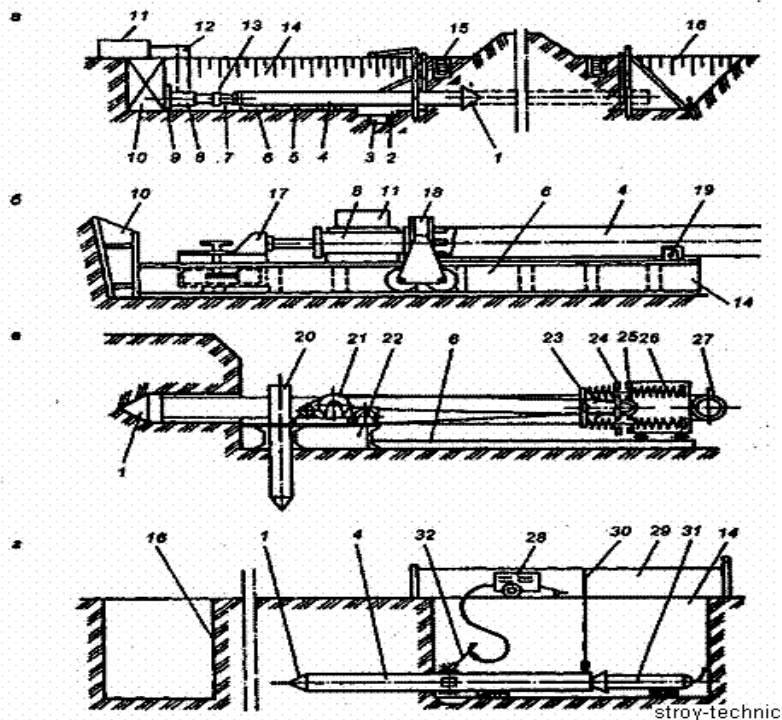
Способы прокола труб: а — общая схема работ; б — прокол установкой ГПУ-600; в — вибропрокол установкой УВВП-400; г — прокол труб с помощью пневмопробойников; 1 — наконечник; 2, 3 — прямки; 4 — прокалываемая труба; 5 — шпалы; б — направляющая рама; 7 — нажимной патрубок; 8 — гидродомкраты; 9 — опорный баишмак; 10 — упорная стенка; 11 — насосная станция; 12 — маслопроводы; 13 — нажимная заглушка; 14, 16 — рабочий и приемный котлованы; 15 — обводной лоток; 17 — подвижный упор; 18 — нажимная плита на тележке; 19 — фиксатор; 20 — свая; 21 — лебедка; 22 — рама; 23 — планка; 24 — ударная приставка; 25 — направляющие стержни; 26 — вибрационный механизм; 27 — электродвигатель; 28 — электросварочный агрегат; 29 — причалка; 30 — отвес; 31 — пневмопробойник; 32 — сварка труб
